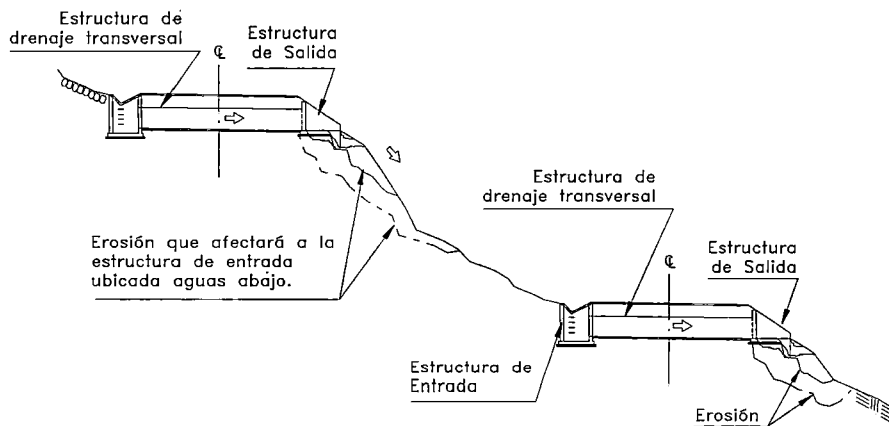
Sistema de Estructuras de Drenaje Transversal que se Encuentran Conectadas.
